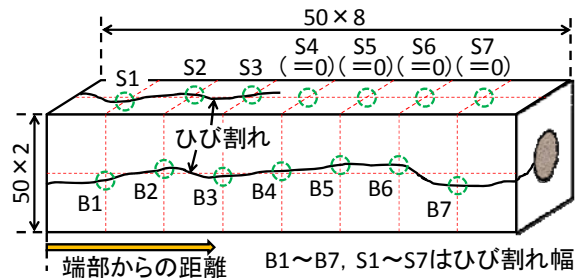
ひび割れ幅測定概要図(単位: mm)
